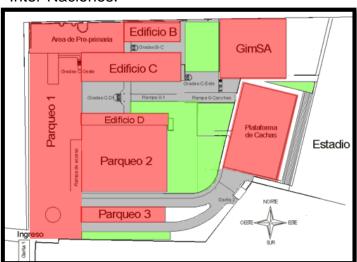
Planta de Conjunto Fuente: www.asedi.edu.gt/lib/foto-cin.JPG
